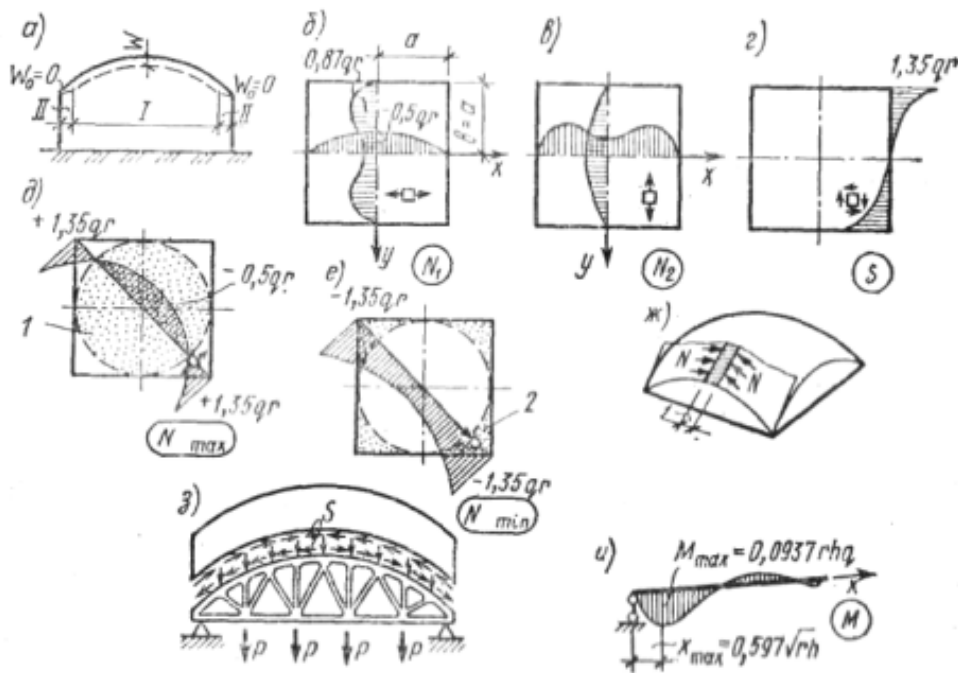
К расчету пологих оболочек положительной гауссовой кривизны на прямоугольном плане:
